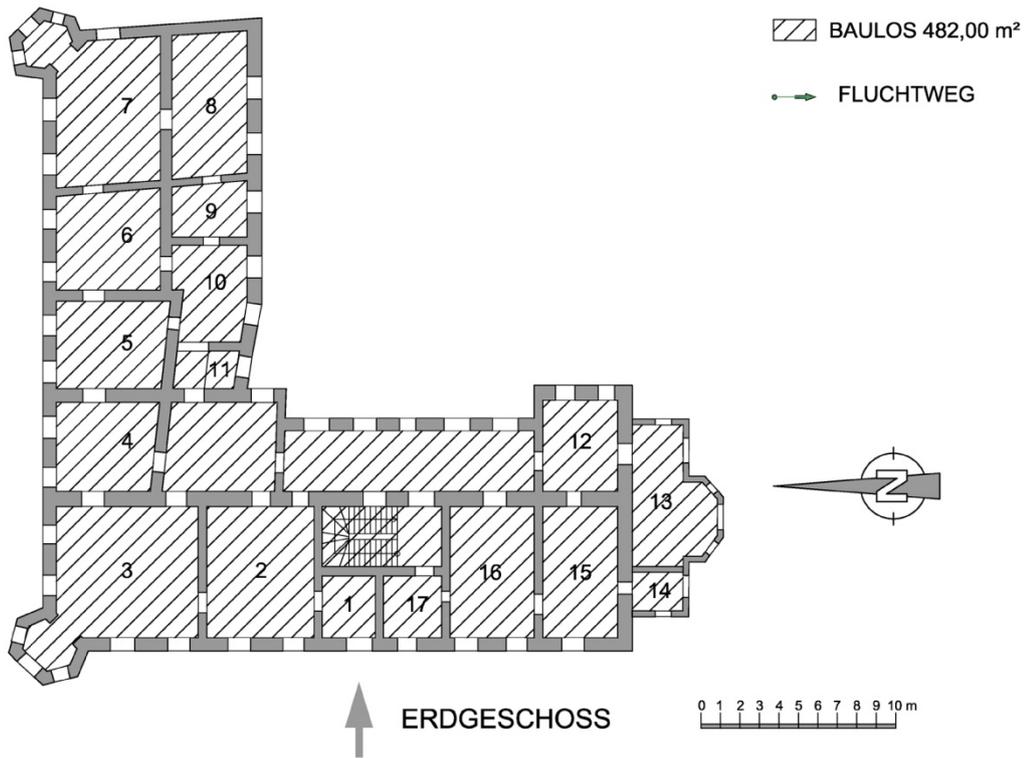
zeigt den Grundriss des Schlosses Ebendorf
